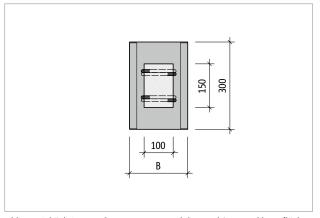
Schöck Sconnex® Typ W-N-VH: Produktgrundriss; Drucklagerfläche 150 mm \times 100 mm
